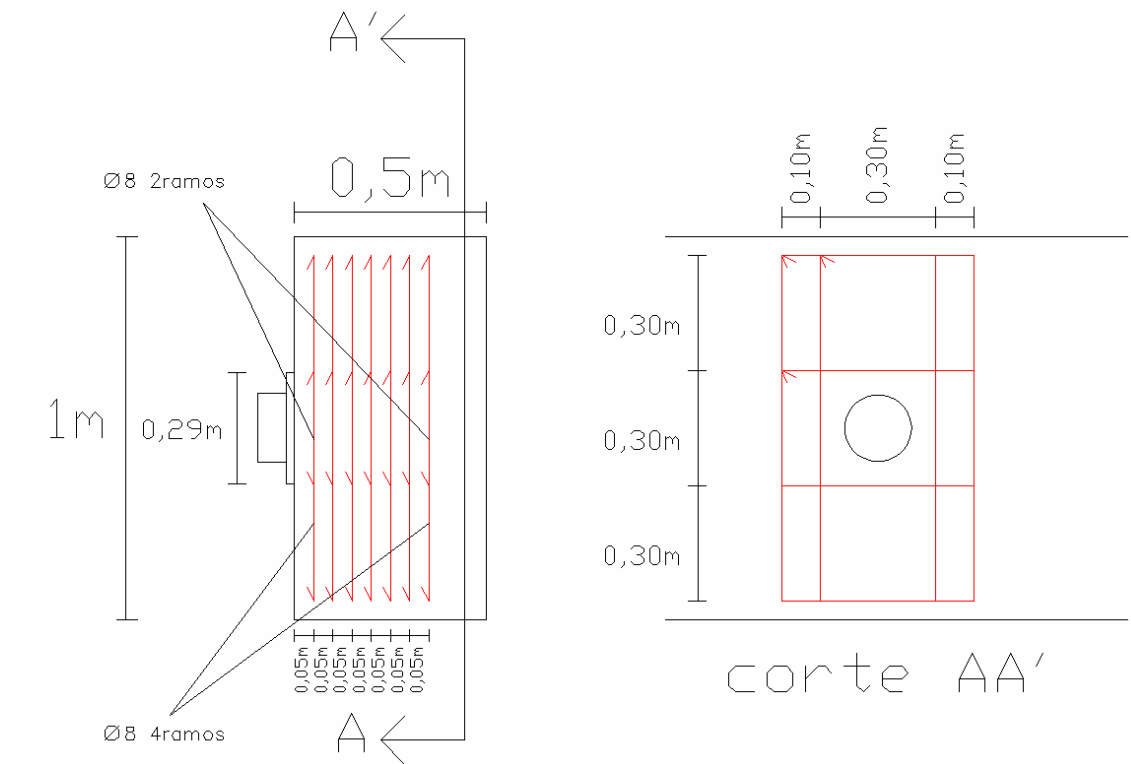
Distribuição da armadura devido a cargas concentradas para a viga de suporte dos cabos
